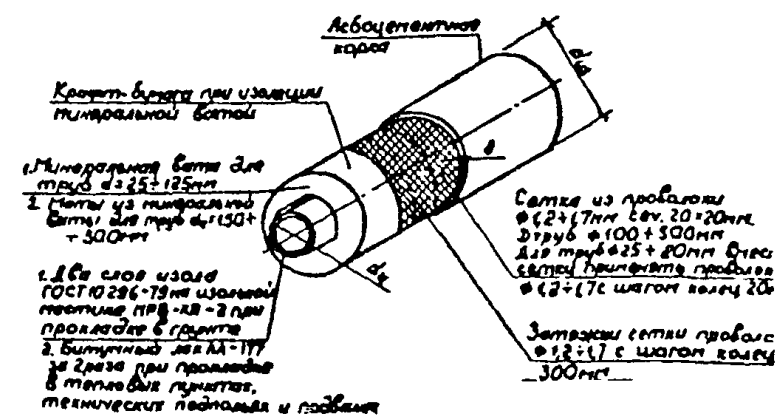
Теплоизоляция трубопроводов на чердаках.
